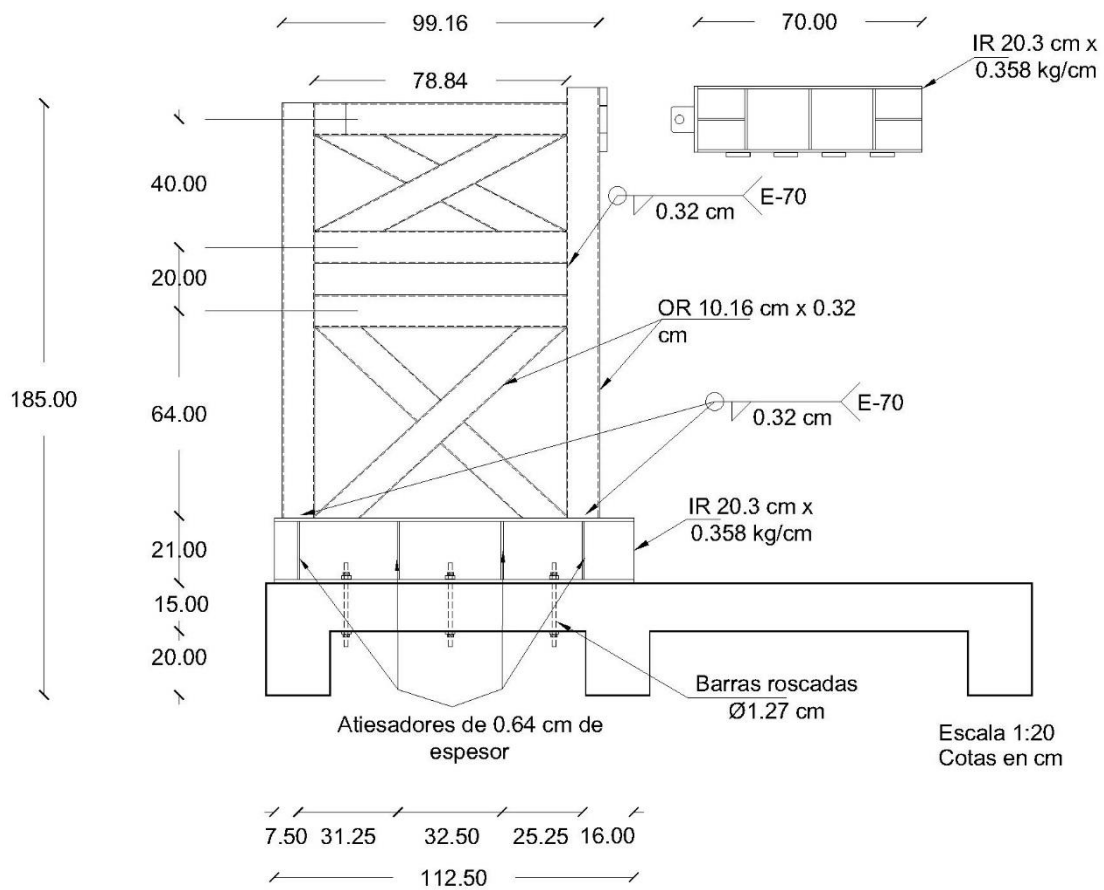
Detalles del sistema de carga lateral (vista frontal), se omiten detalles de muro por claridad.
